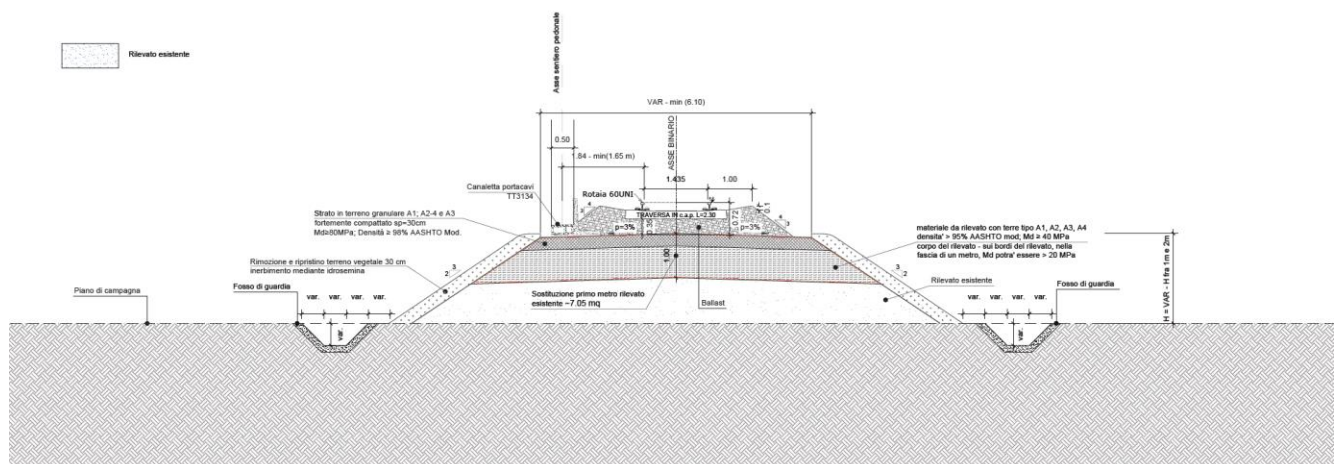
Sezione tipologica 1 – rilevati fino a 2 m di altezza (Doc. Rif. [2])
